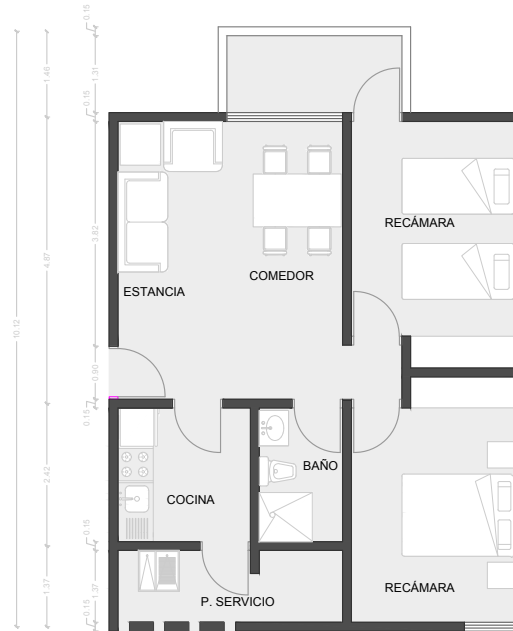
Planta arquitectónica original departamento tipo B-01 Fuente: Elaboración propia
